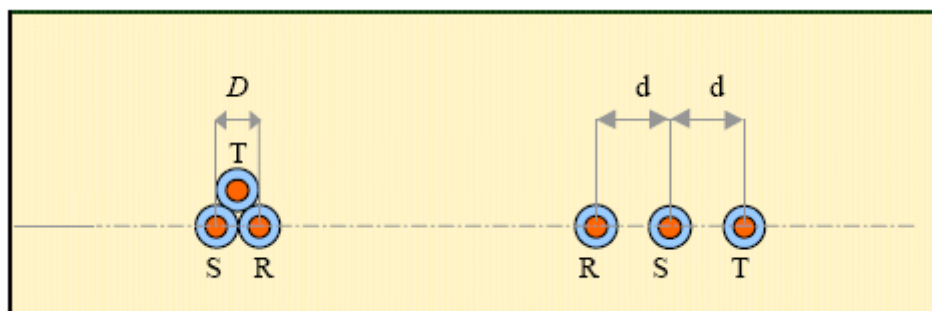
Modalità di disposizione delle fasi a trifoglio o in piano
